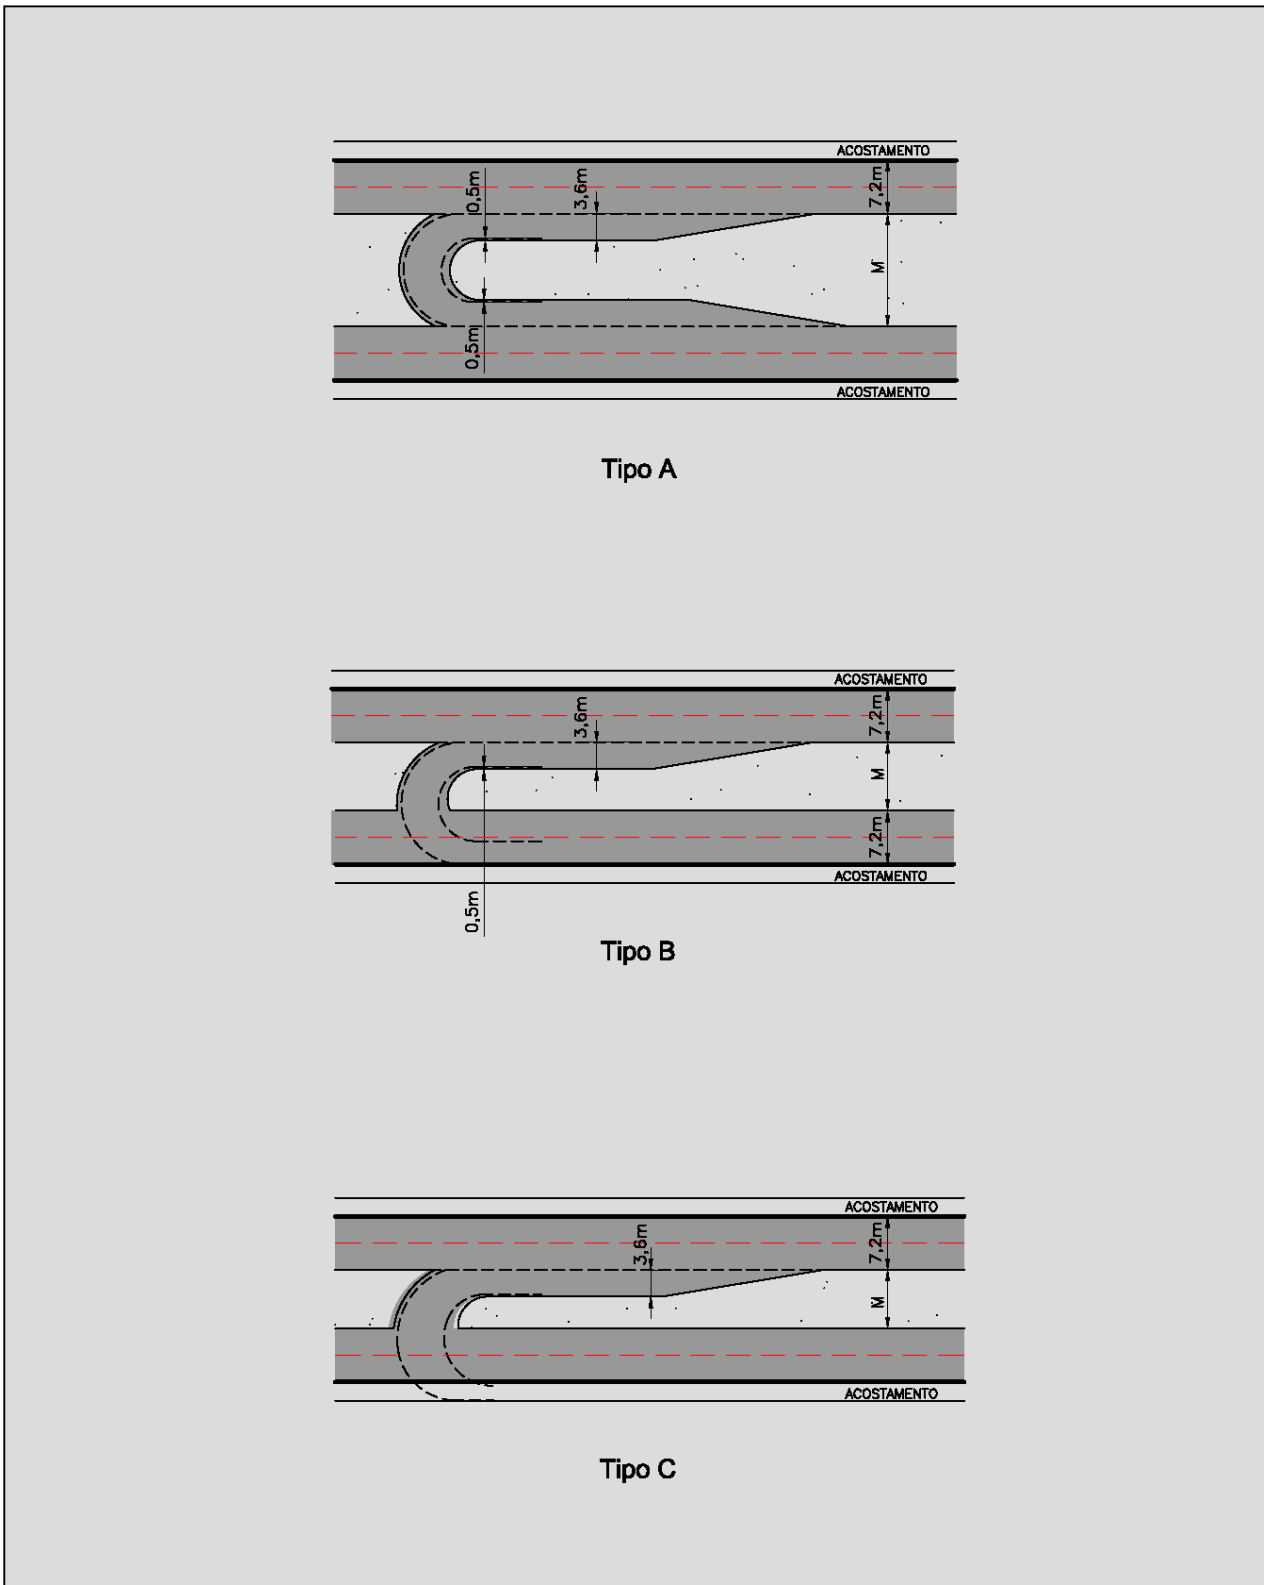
Dimensões mínimas do canteiro central para retornos em “U”
